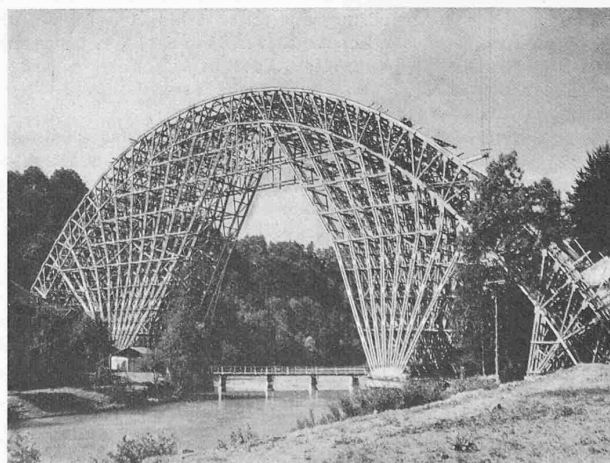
Lehrgerüst der 134 m weit gespannten Kräzernbrücke
